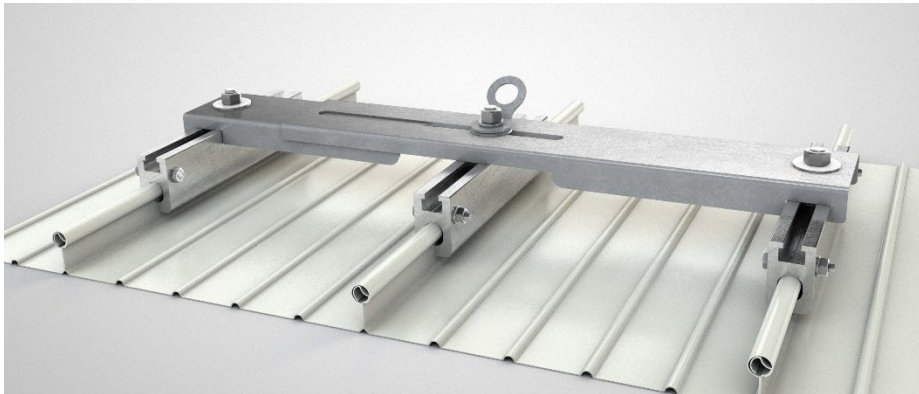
Anschlagereinrichtung Typ A, Typ: ABS-Lock® Falz VI
